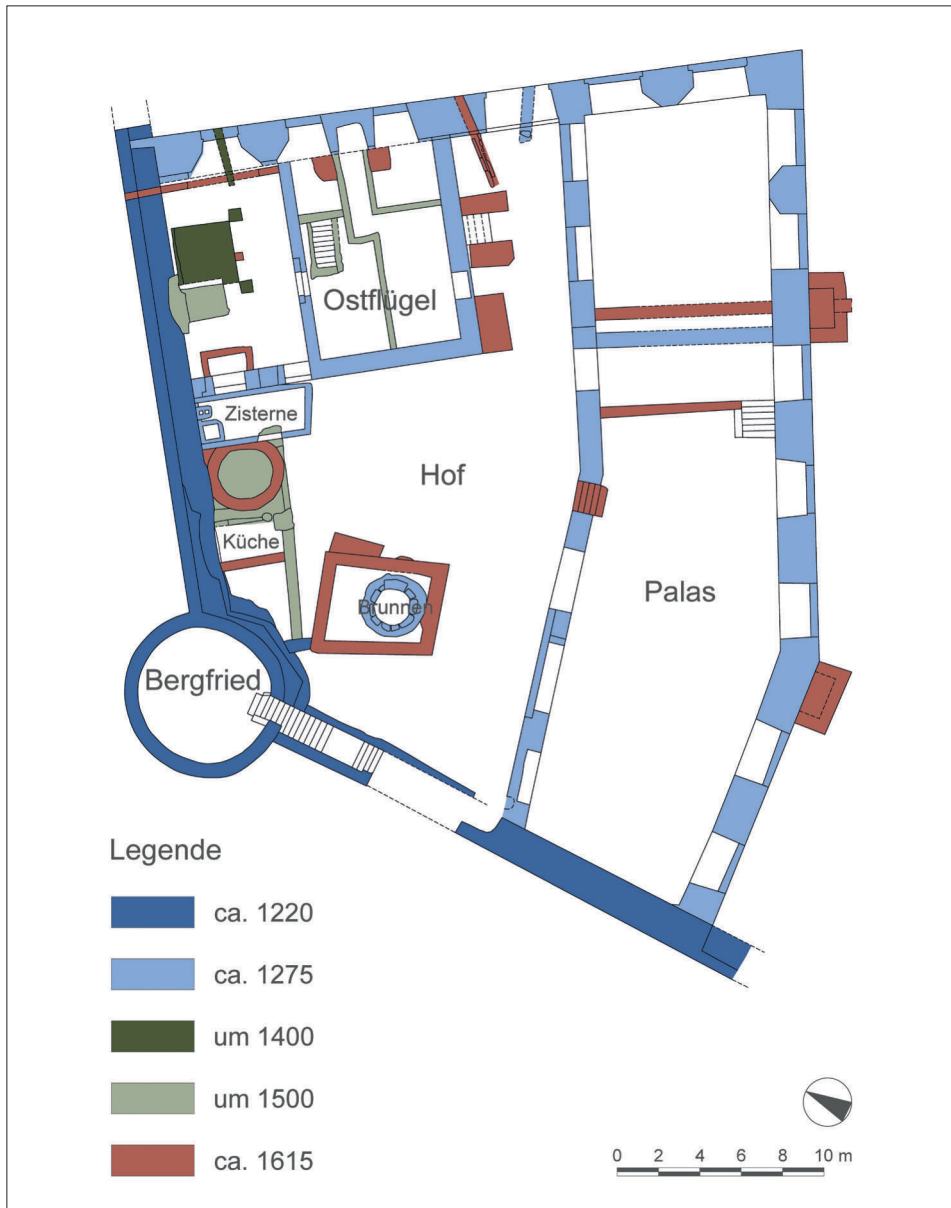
Grundriss der Kernburg mit Baualterplan.
